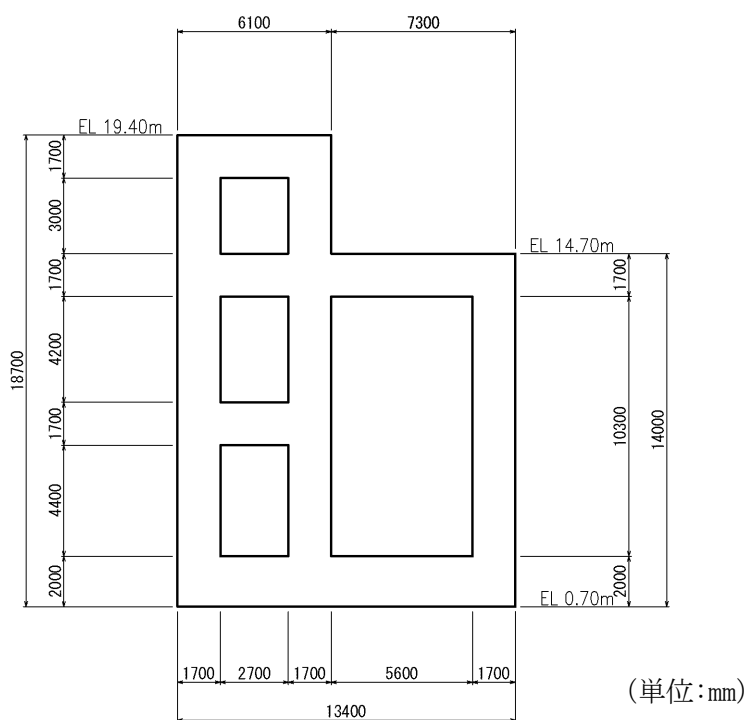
第1 ベントフィルタ格納槽 断面図 (A-A断面)
